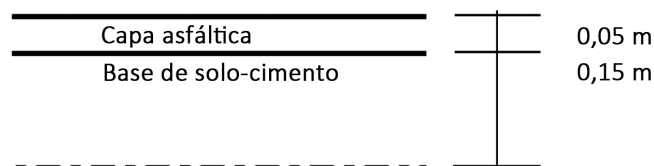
Estrutura genérica original dos pavimentos restaurados neste Estudo de Caso
